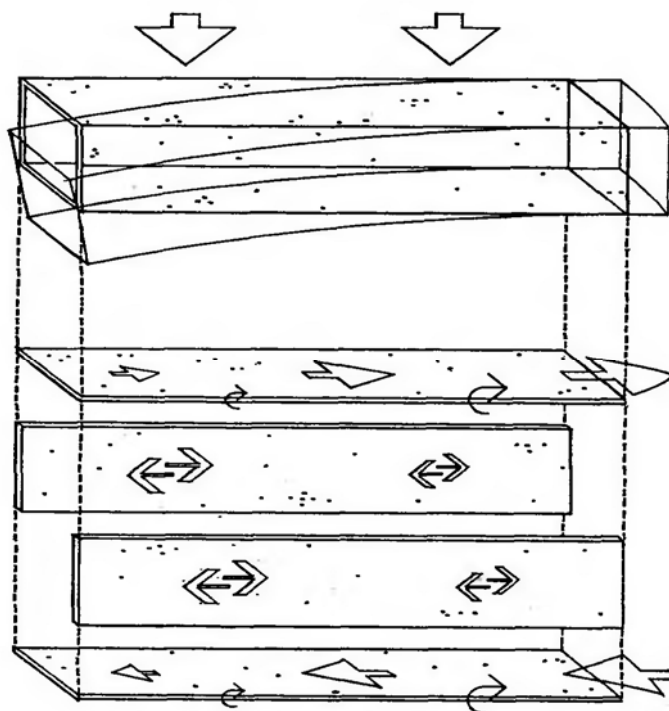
Принцип действия труб высотного здания соответствует поведению горизонтальной консольной балки коробчатого сечения под вертикальной нагрузкой
